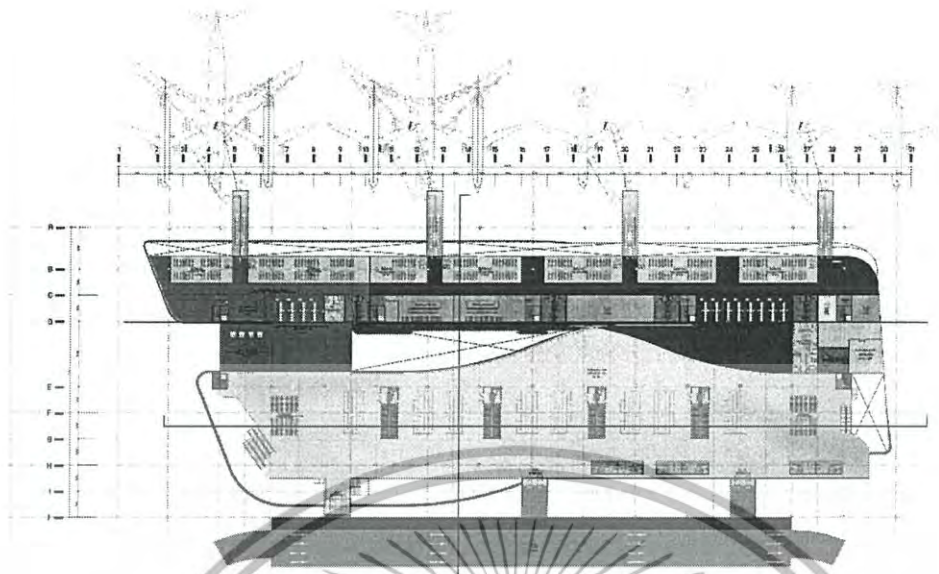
แสดง 1<sup>st</sup> Arrival Floor Plan
